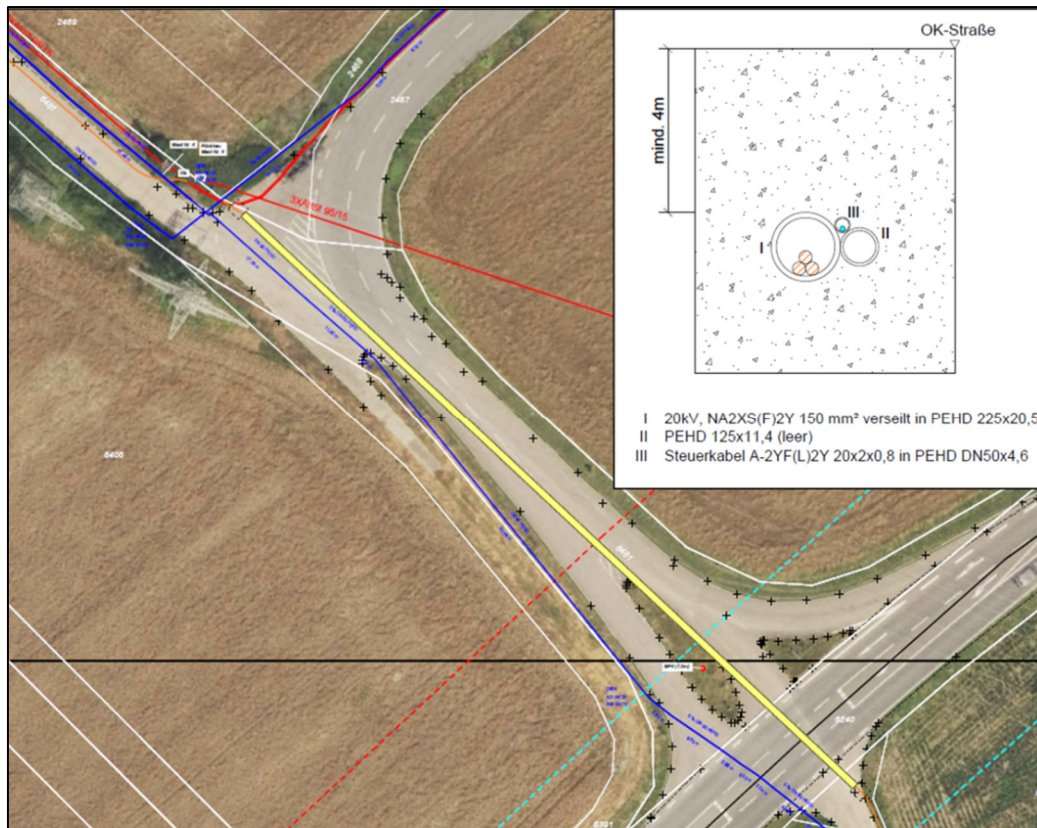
Lageplan mit der geplanten HDD-Bohrung im Bereich der L722 mit dem vorgesehenen Grabenprofil.
